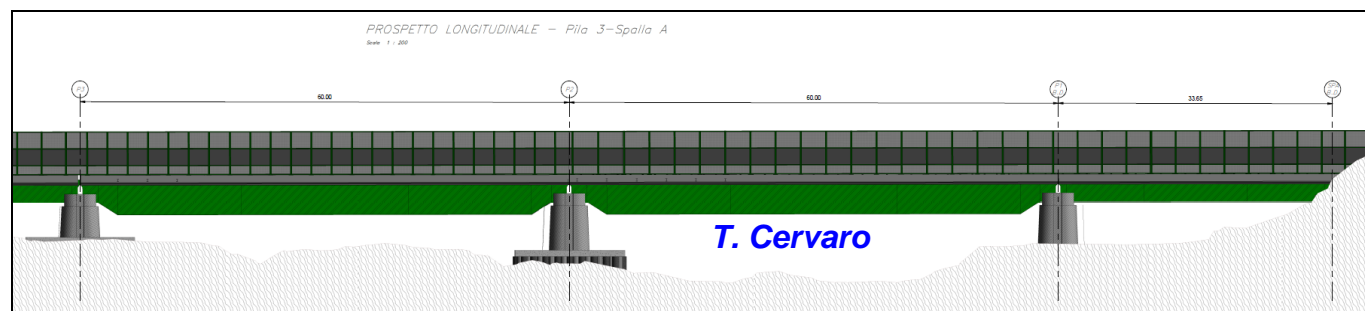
Prospetto (Pila 3 – Spalla A) del viadotto in progetto sul T. Cervaro.
